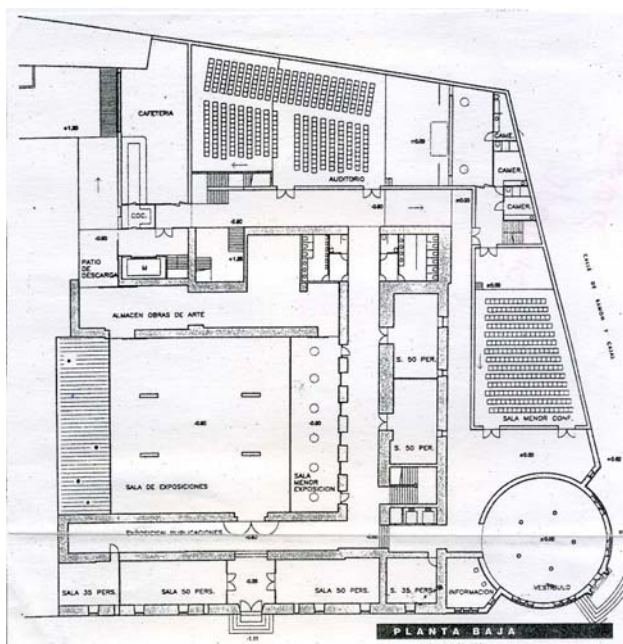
Centro Cultural y de Postgrado: planta baja, por Carlos Punte, 2000-2002.
